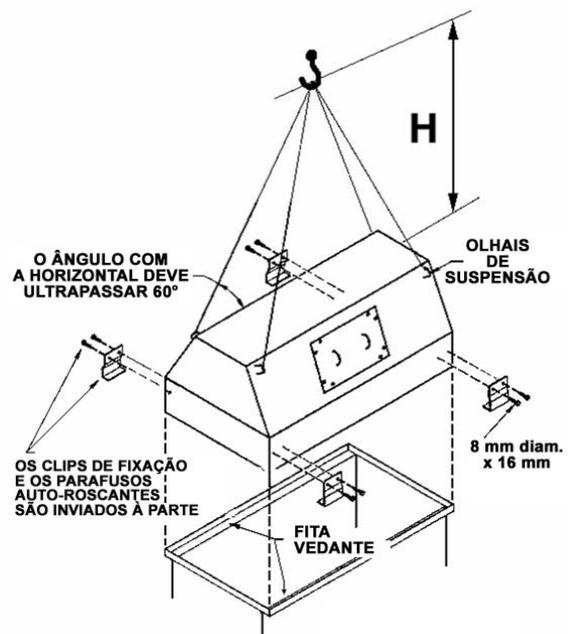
Montagem da secção de pleno de descarga sobre a secção superior.
